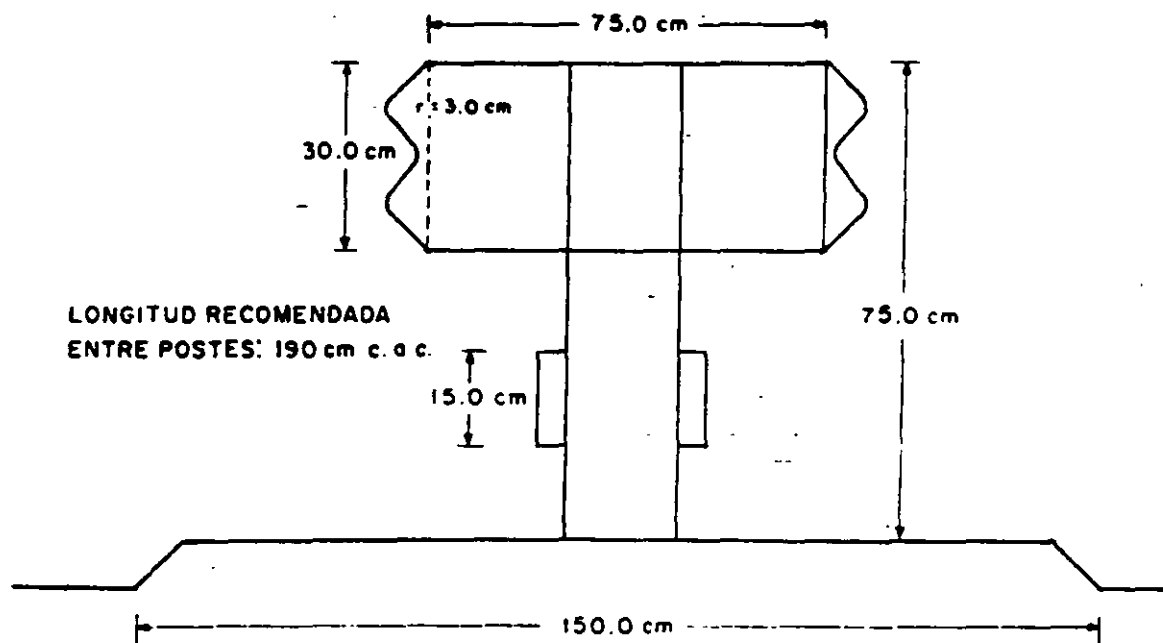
BARRERA RECOMENDADA POR LA DIVISION DE CAMINOS DEL ESTADO DE CALIFORNIA
